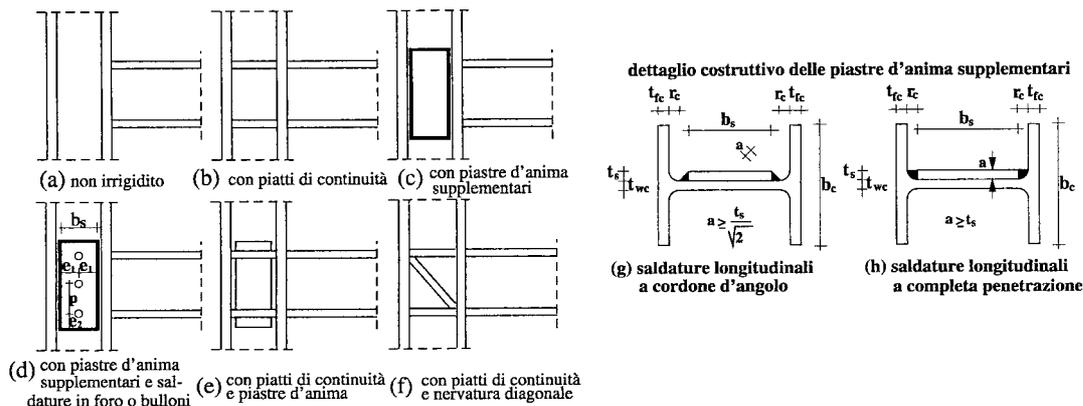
Dettagli costruttivi di pannelli nodali irrigiditi.
